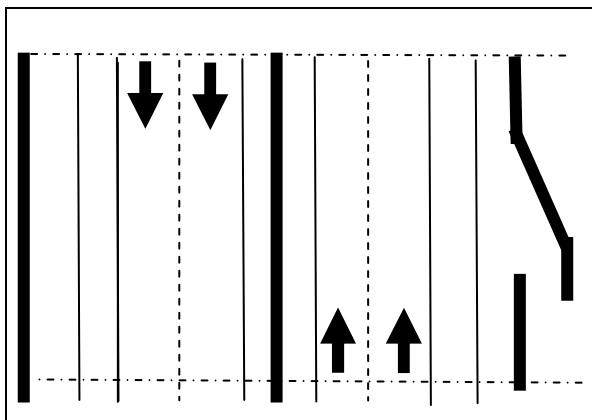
Doorsteek in de tussenberm t.b.v. hulpdiensten zonder beweegbare fysieke afsluiting (aansluiting A1 – A30).
